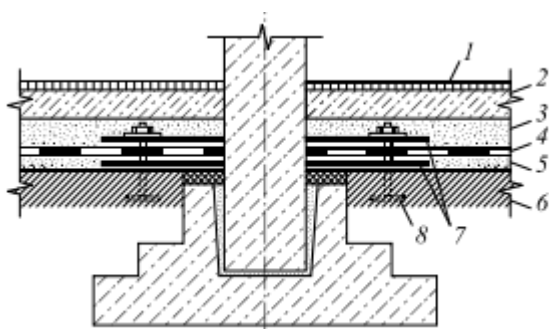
Конструкция гидроизоляции около отдельного фундамента под сборную железобетонную колонну: 1 – покрытие пола; 2 – конструкция пола подвала; 3 – защитная цементная стяжка 20 мм; 4 – рулонная гидроизоляция; 5 – выравнивающая цементная стяжка 30 мм; 6 – бетонная подготовка; 7 – стальной лист; 8 – анкерный болт
